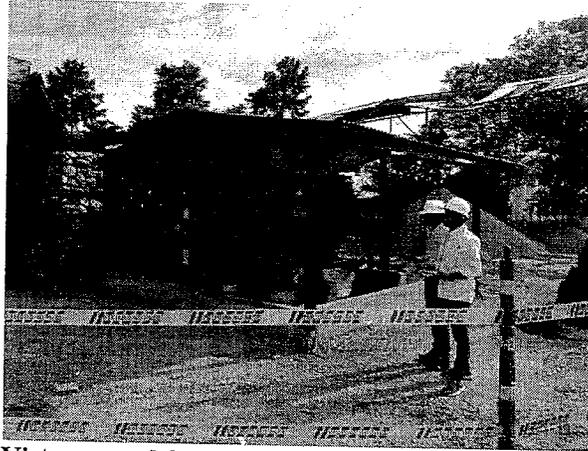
Vista general área planta generadora de energía eléctrica, construcción de diques y piso duro en concreto.
